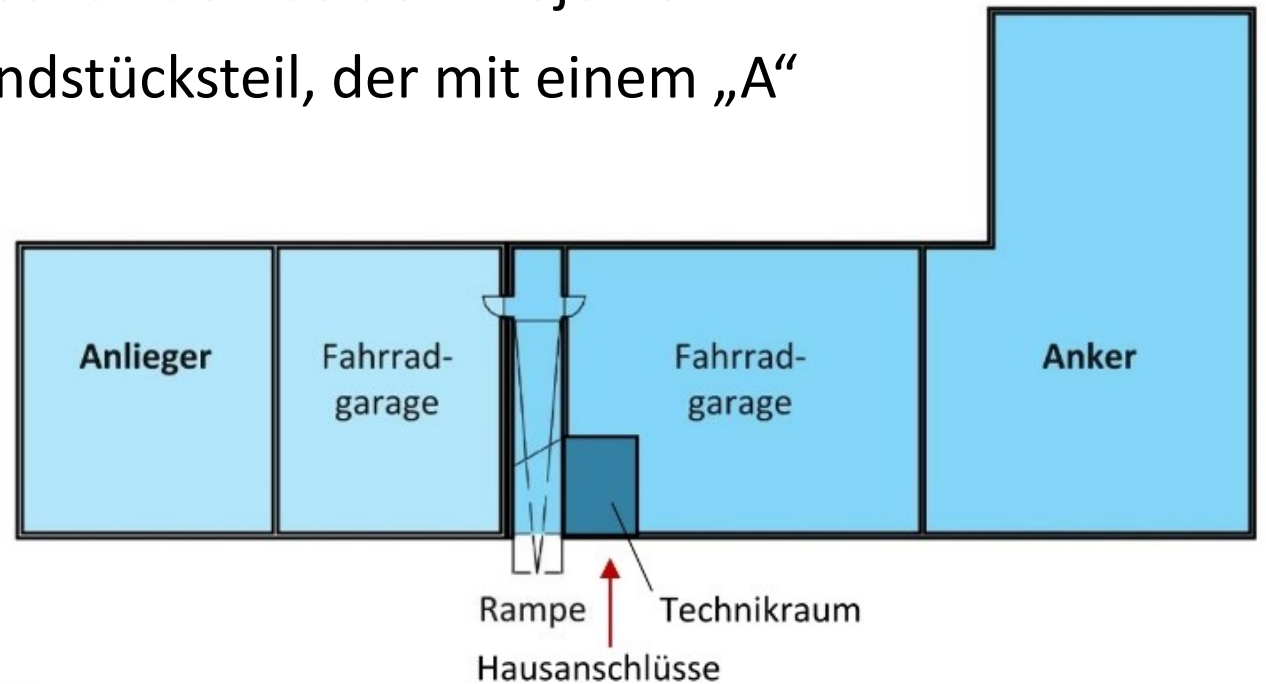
schematischer Grundriss des Untergeschosses mit Lage des Technikraums von MU 7 (ohne Maßstab)
